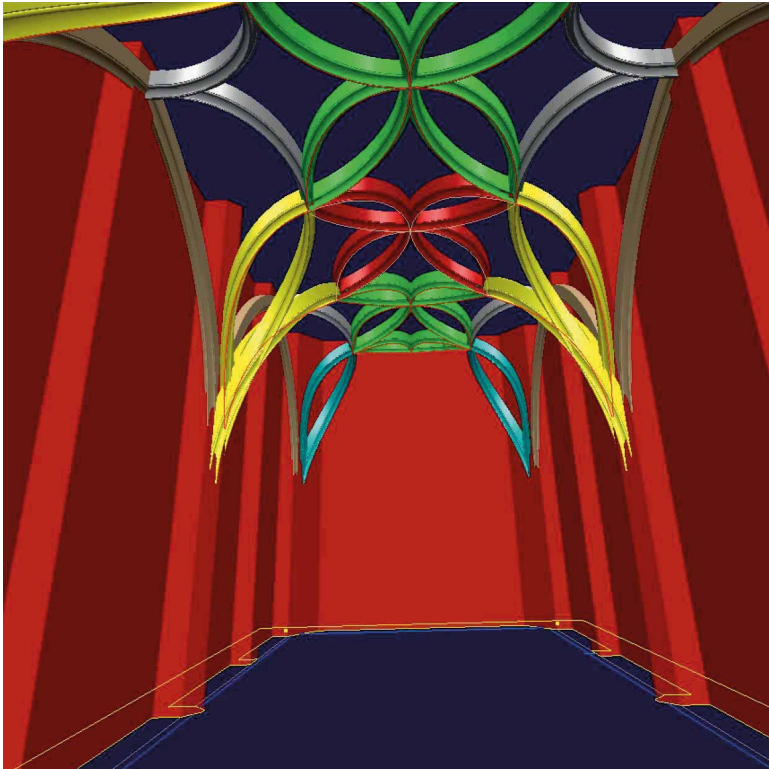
© 2011 Bauer-Lauterbach – Nachkonstruktion Rippenwerk Landhauskapelle nach eigener Vermessung - Perspektive
